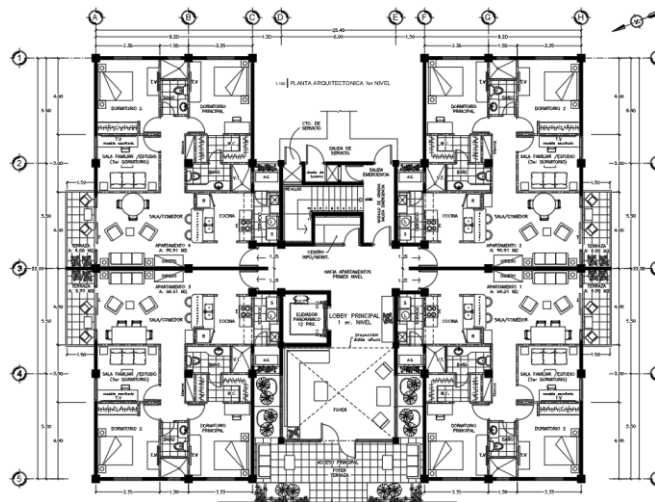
Distribución de Planta de Torre Los Hibiscus.
